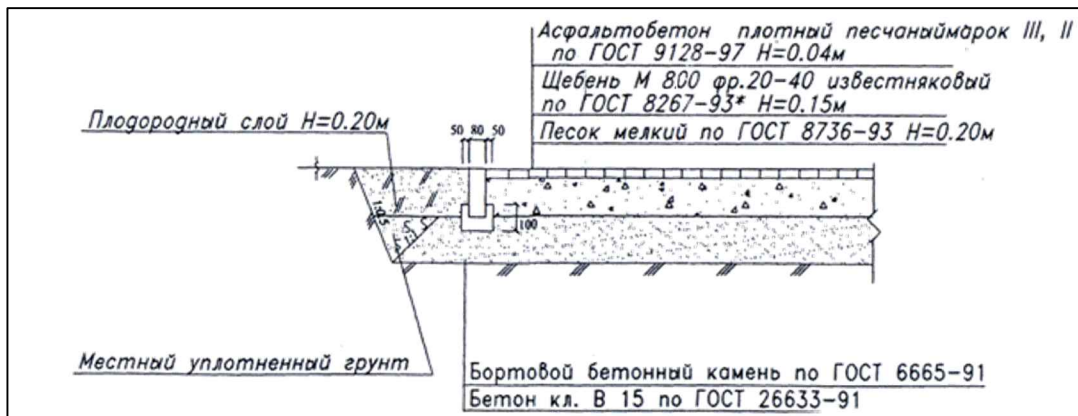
Конструкция тротуара, автомобильного проезда с асфальтобетонным покрытием
